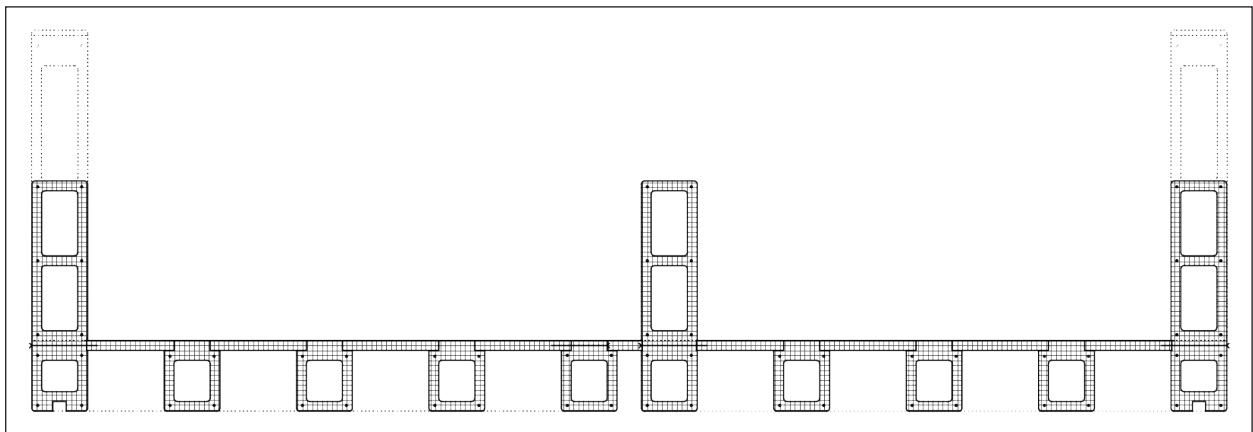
Grundriss, Stahlbetonhohlquerschnitt
